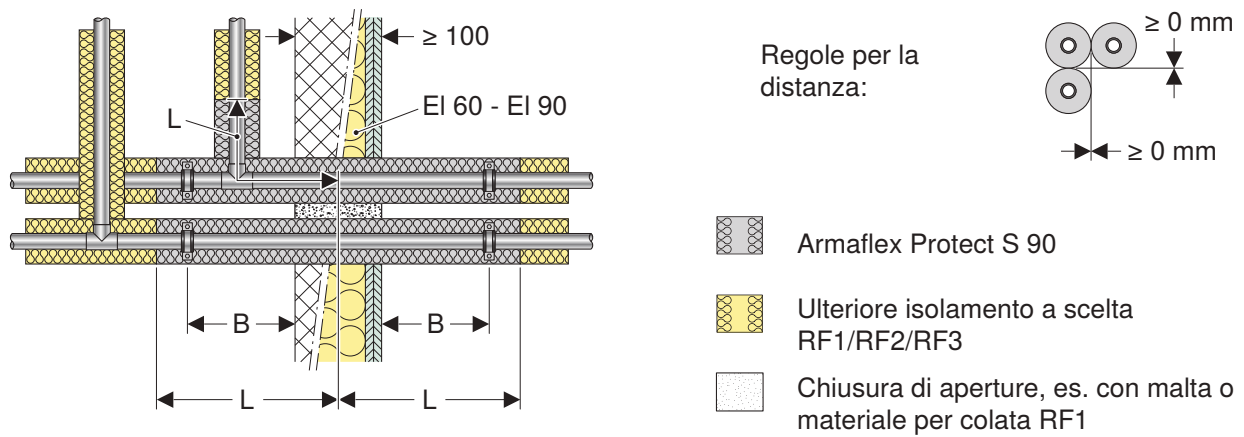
Passaggio per tubi in parete in muratura o parete leggera con Geberit Mepla o Geberit PushFit e isolamento Armaflex Protect
